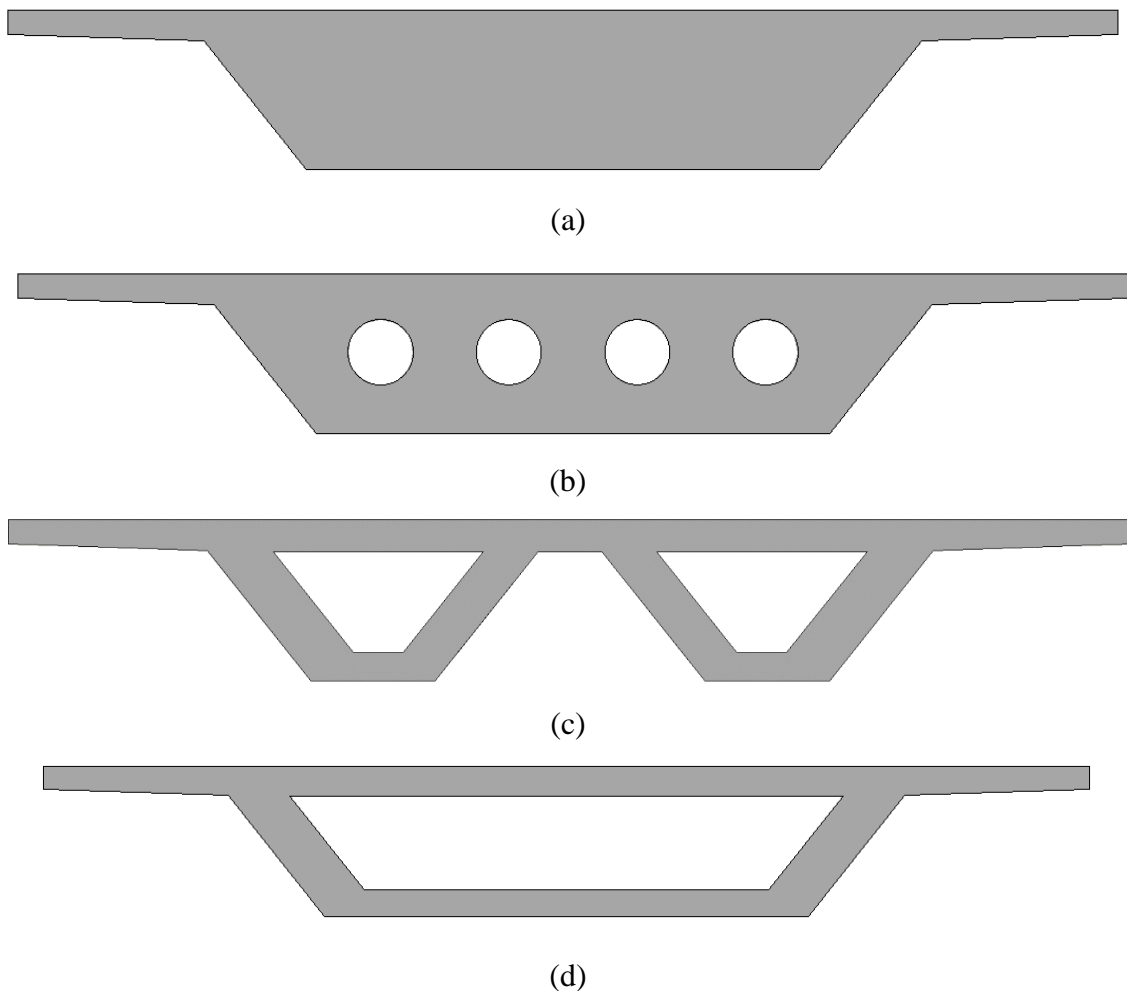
Secciones tipo estudiadas: (a) losa maciza; (b) losa aligerada; (c) vigas artesas; (d) sección cajón.
